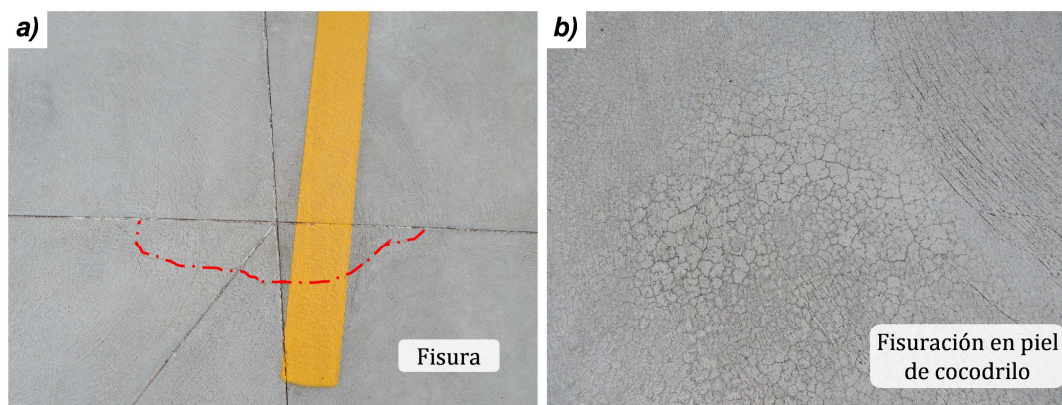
Losa de hormigón convencional; a) fisuración en las esquinas de las juntas; b) fisuración en piel de cocodrilo
